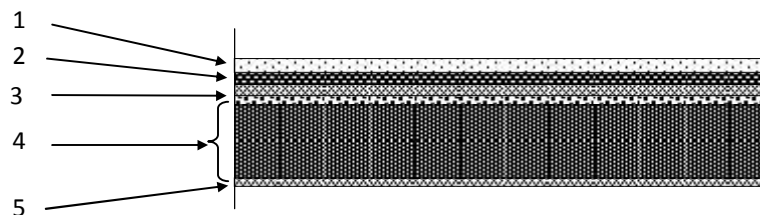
Coupe verticale de la dalle pleine (balcon).
